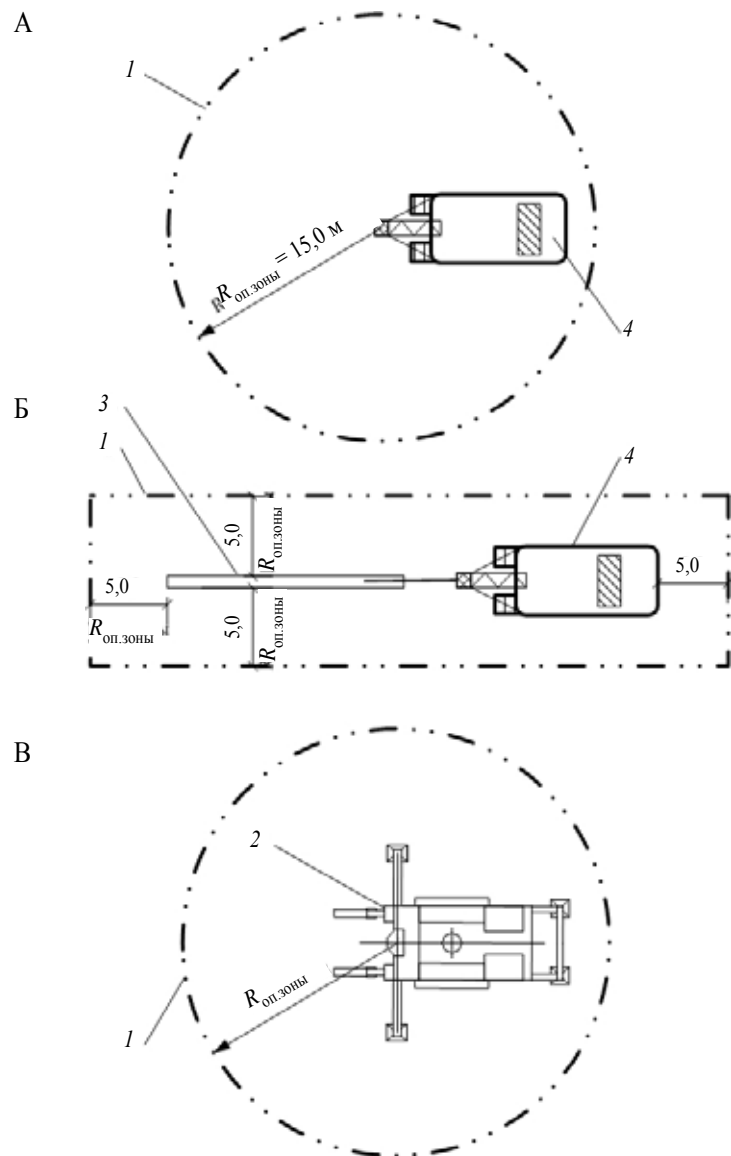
Расчетная схема определения опасных зон при устройстве свай: 1 – граница опасной зоны; 2 – установка вдавливания свай; 3 – свая (арматурный каркас); 4 – копер или буронабивная установка
